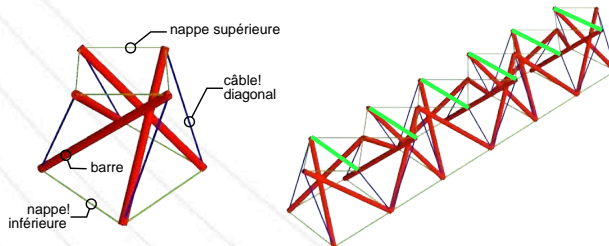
Poutre de tensegrité formée par assemblage de modules à 4 barres et raidie par blocage de mécanismes en nappe supérieure
